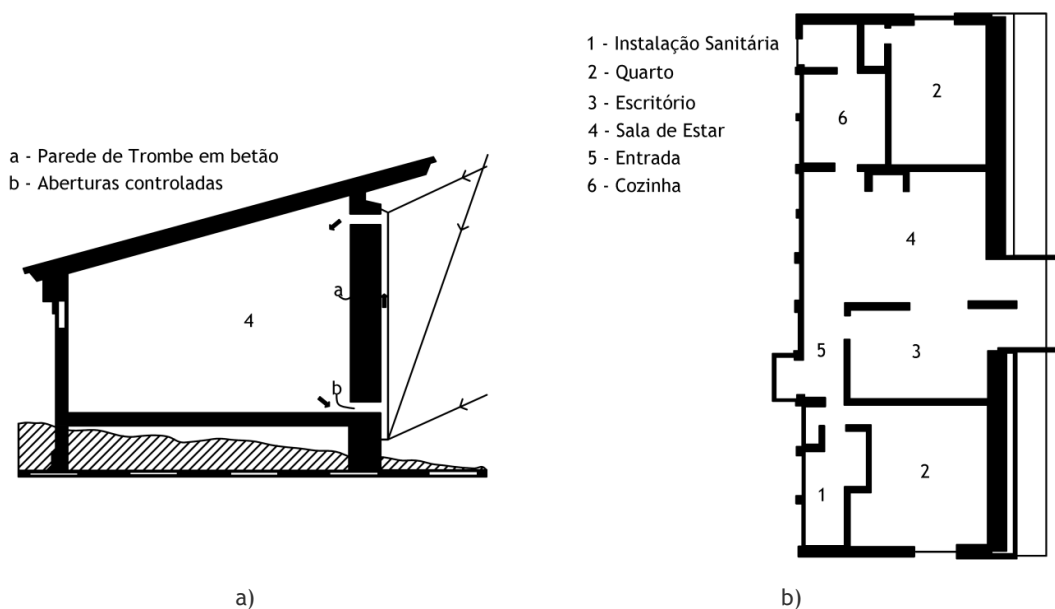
Casa Solar em Odeillo, França: a) corte esquemático; b) planta (adaptado de [9]).
